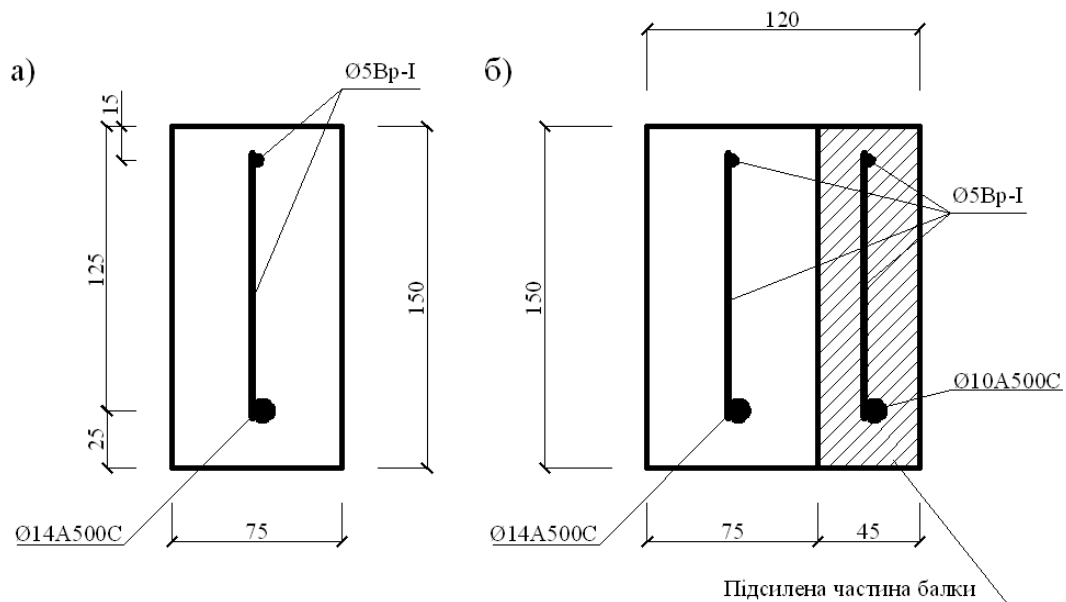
Схема конструювання дослідних балок: а – балки Б-1-1-1, Б-1-1-2, Б-1-2-1, Б-1-2-2, Б-1-2-1т, Б-1-2-2т; б – балки, що піддані підсилению торкретуванням Б-1-1-1т, Б-1-1-2т
